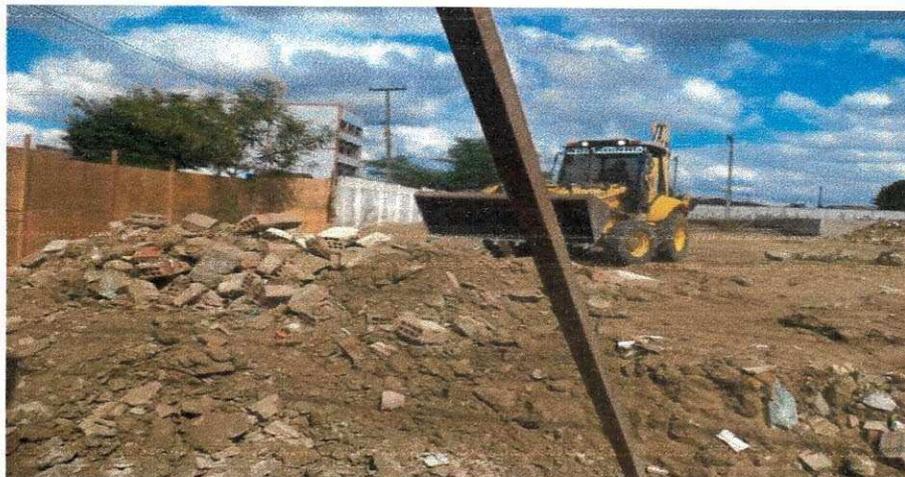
Demolição do muro, cintas e pilares da murada principal.
